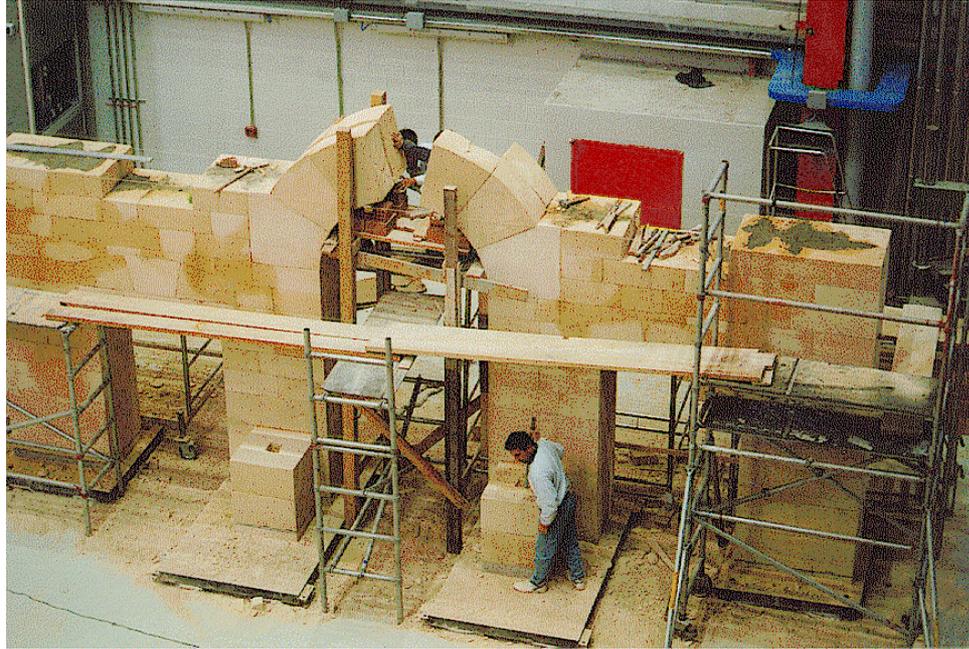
Realizzazione dell'arco centrale del piano inferiore.
